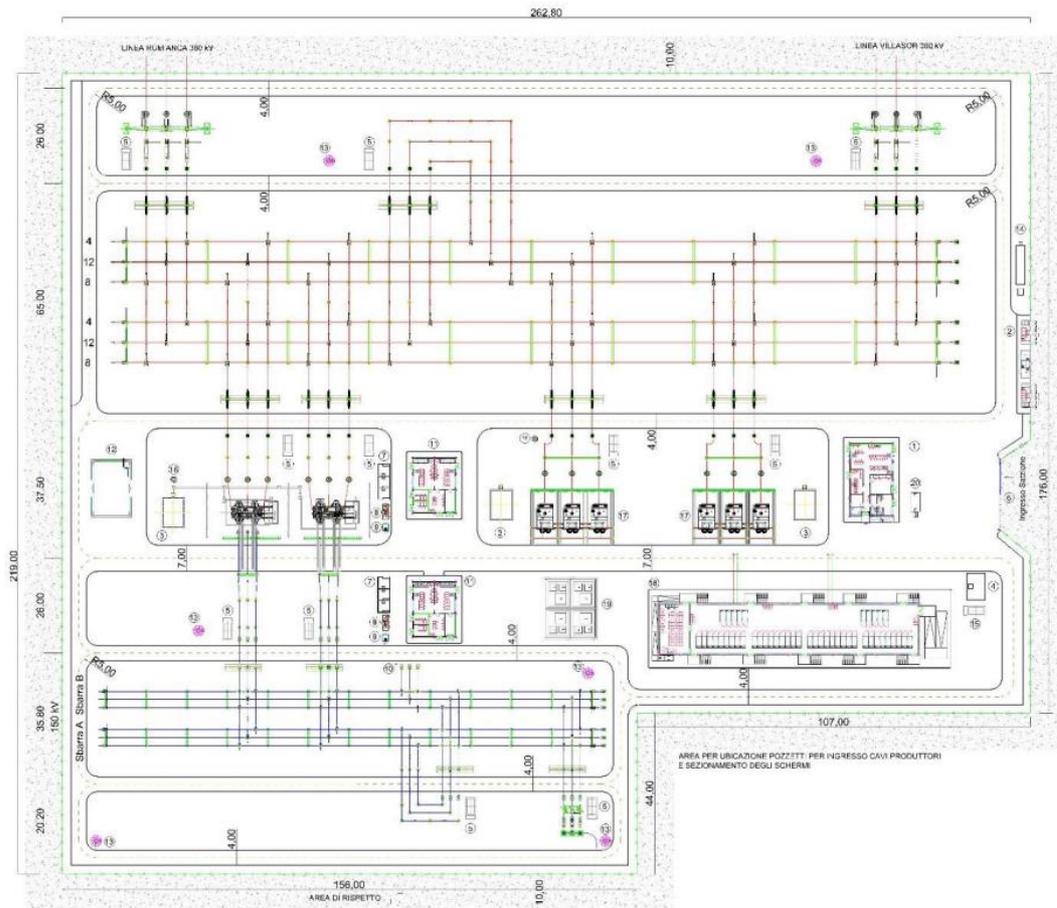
Planimetria opere elettromeccaniche nuova SE TERNA 380/150/36 kV
